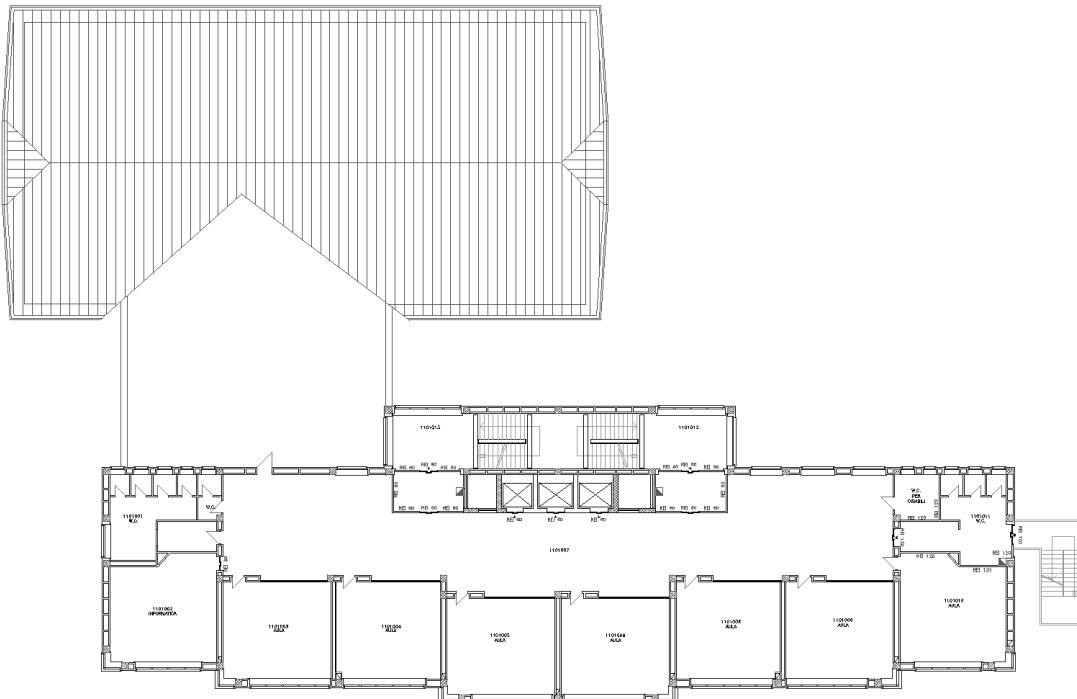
\_PIANTE PIANO PRIMO\_SECONDO\_TERZO
